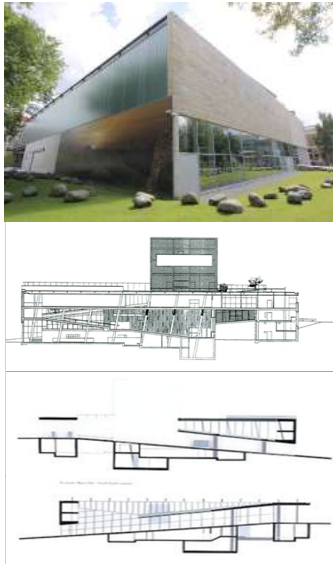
Museo Kunsthall, alzado principal y secciones transversales donde se aprecian los juegos de rampas Rotterdam, 1987 - 1992, Rem Koolhaas.
